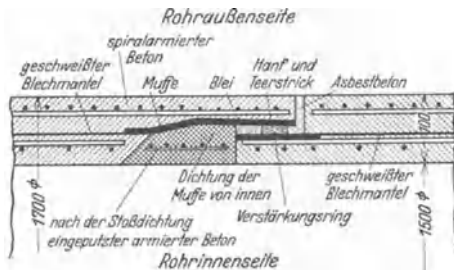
Muffenverbindung der Schleuderbetonrohre.
